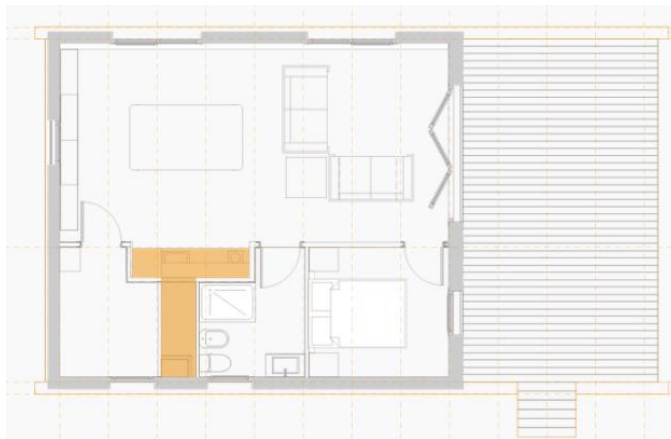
Planta Refúgio Inteligente NOEM 96 m².
